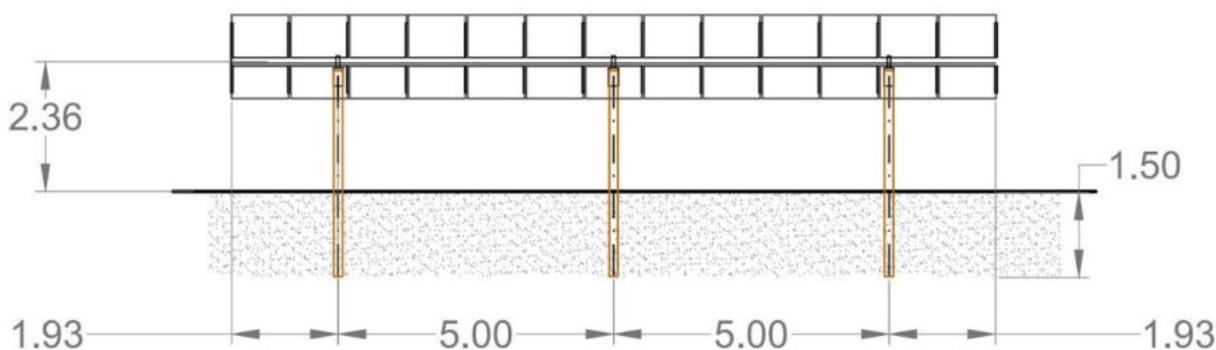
Stralcio prospetto struttura di supporto 2x13
